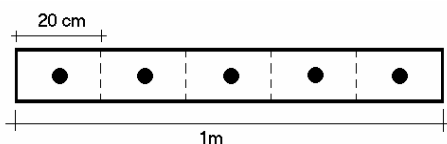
Пример размещения дискретной арматуры при заданном шаге 20 см
